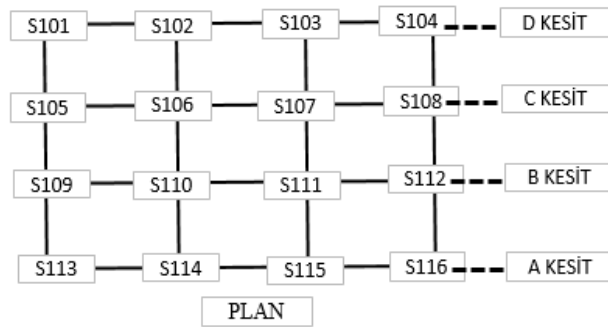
Üç katlı bina kiriş planı ve numaralandırılması
